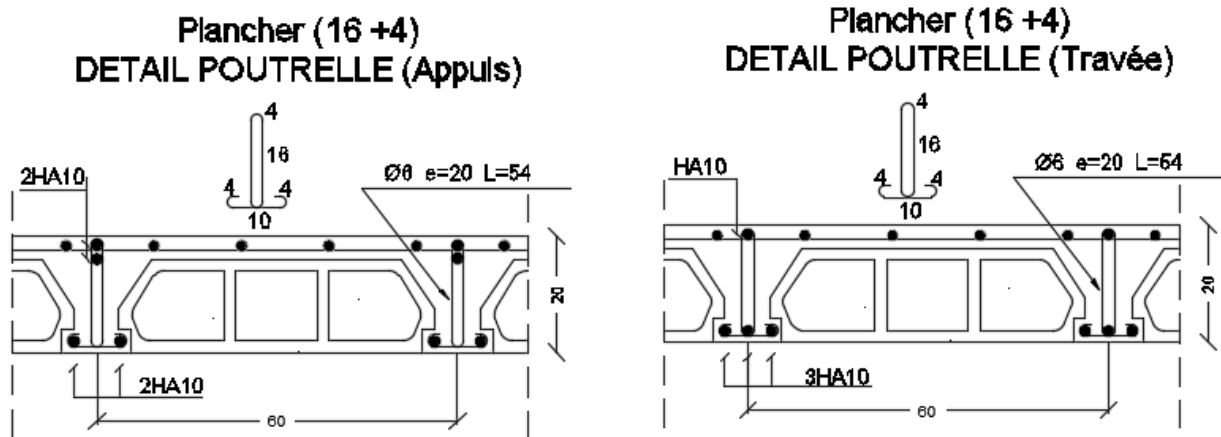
Schéma de ferrailage des poutrelles du plancher corps creux
